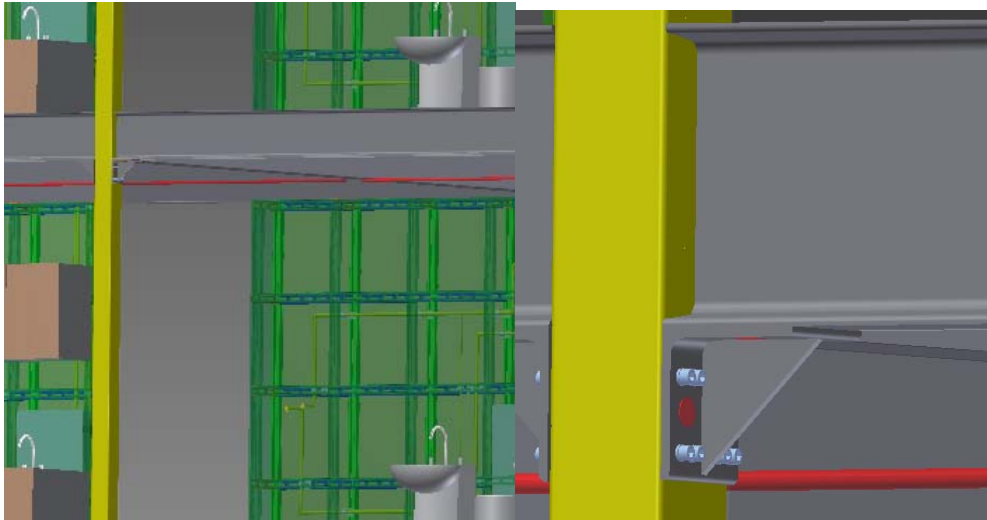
Techo y zona de apoyo en forjado (izda.). Detalle del apoyo (dcha.)
